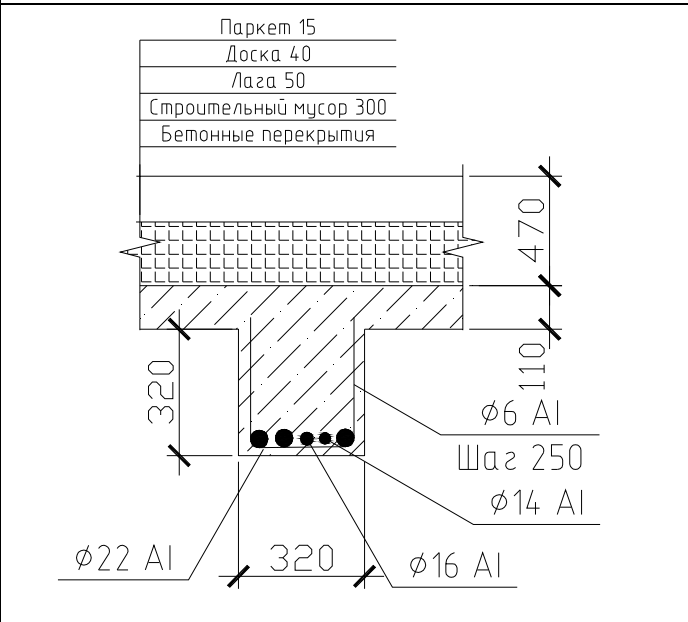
Балка ж/б перекрытия над четвертым этажом в осях «9-11/А-Г»
